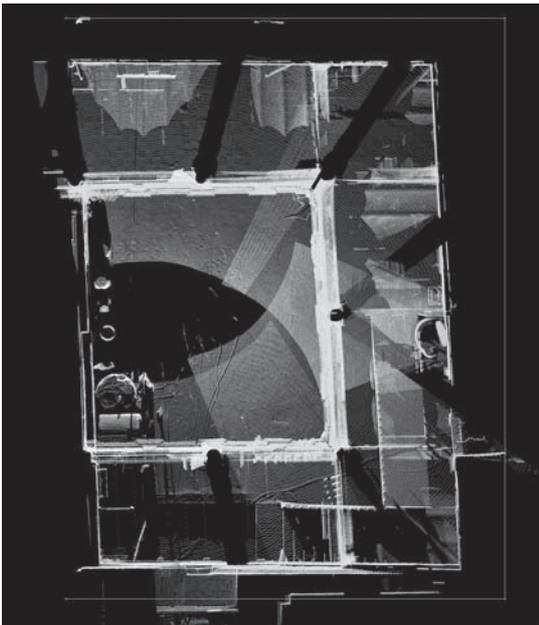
Planta baja del palacio. Nube de puntos realizado por el escáner-láser 3D
